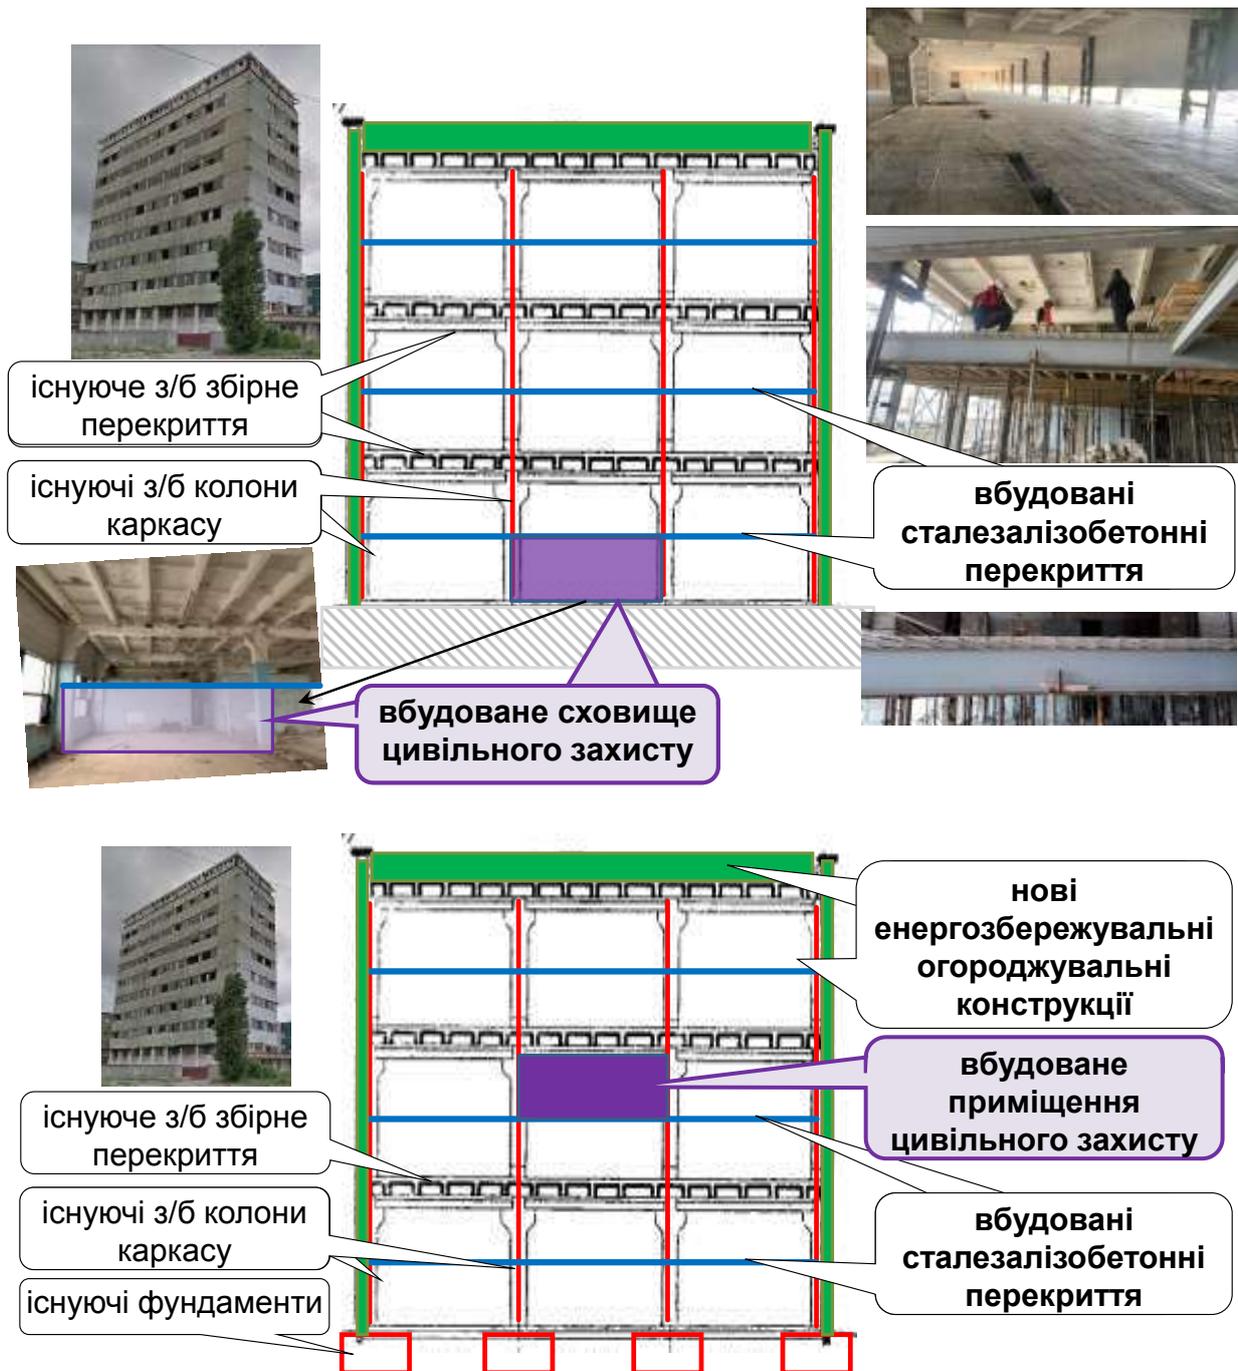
Варіанти влаштування вбудованих сховищ у багатоповерховій промисловій будівлі
